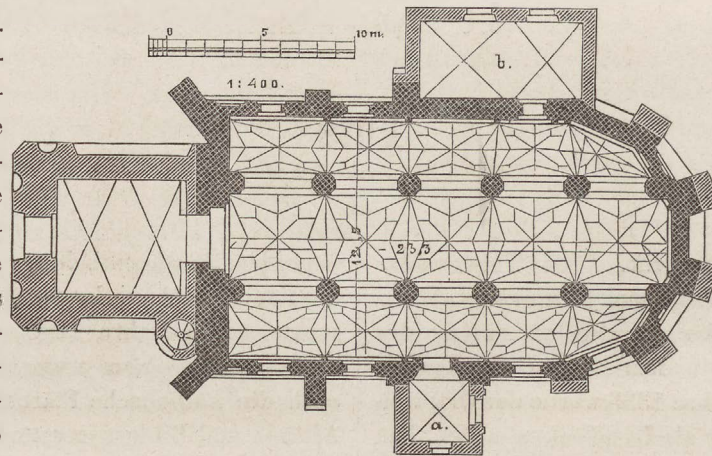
Tütz. Grundriss der kathol. Kirche.
